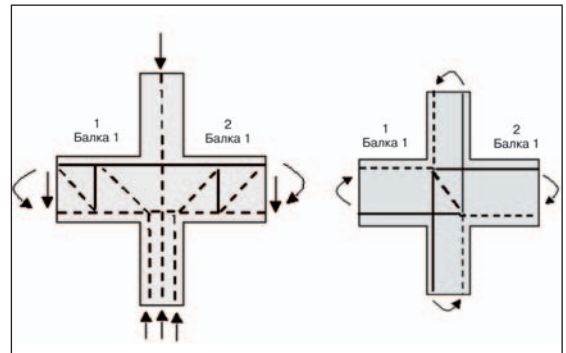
Модель поперечины и тяги для внутренних узлов балка-колонна.
